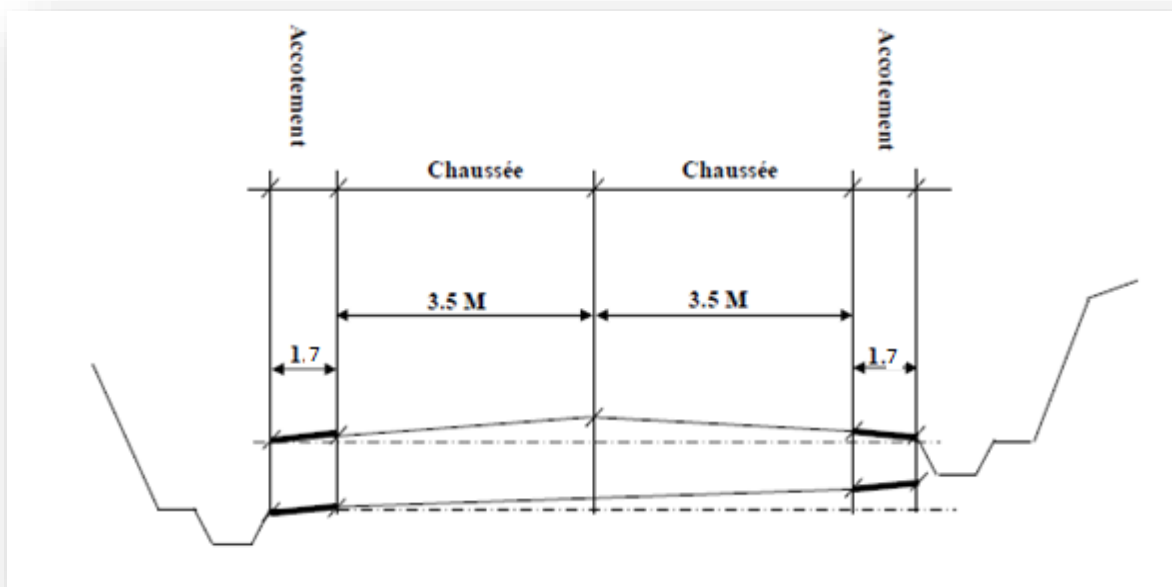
2:Schéma explicatif d'une Coupe transversale de la chaussée prévue.
